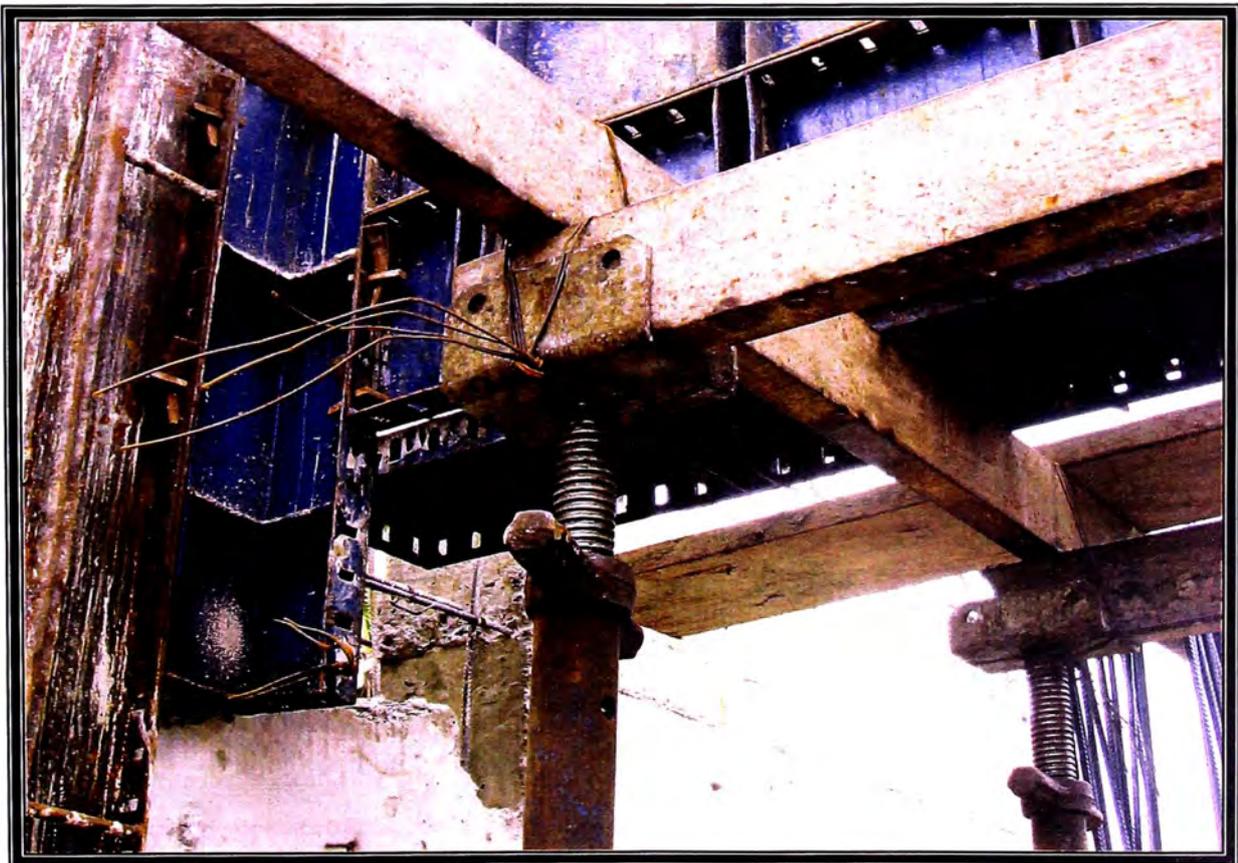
DETALLE DE SOPORTE DEL PUNTAL.
